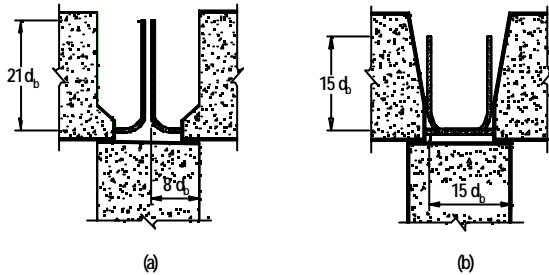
Conexión viga-columna en china (Restrepo et al., 1989)
